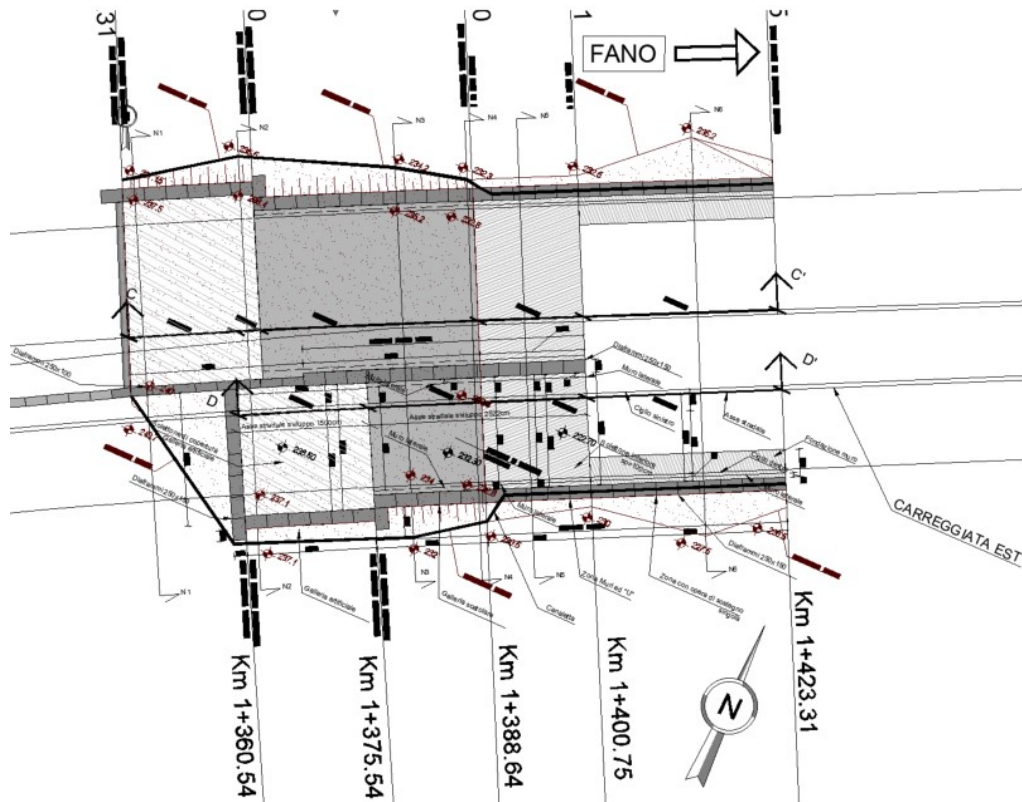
Planimetria galleria artificiale San Lazzero - Imbocco Lato Fano
